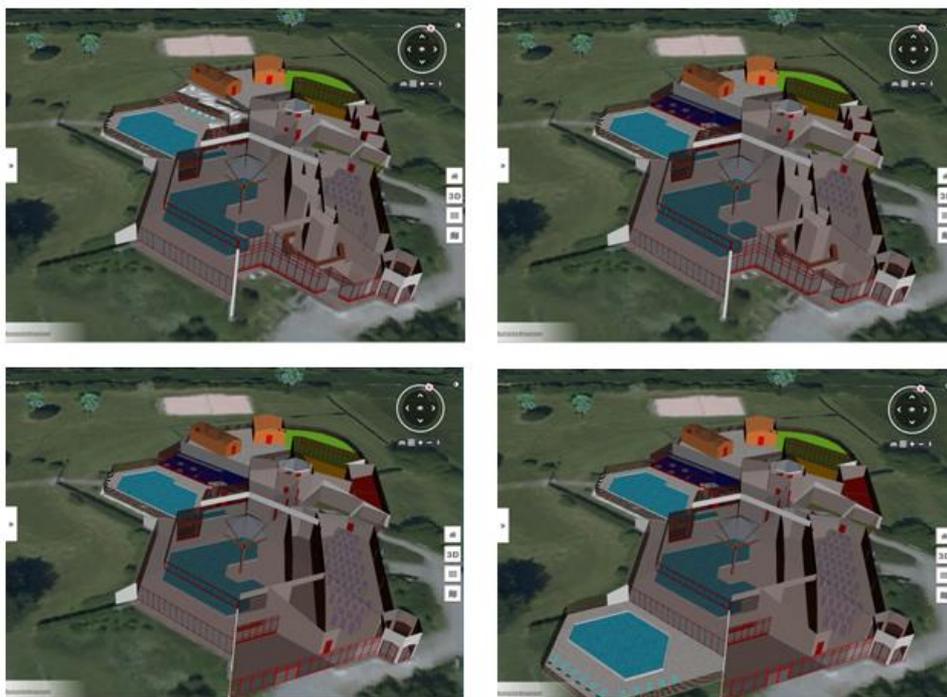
Planungsvarianten 1-4 Solebad Niedernhall
